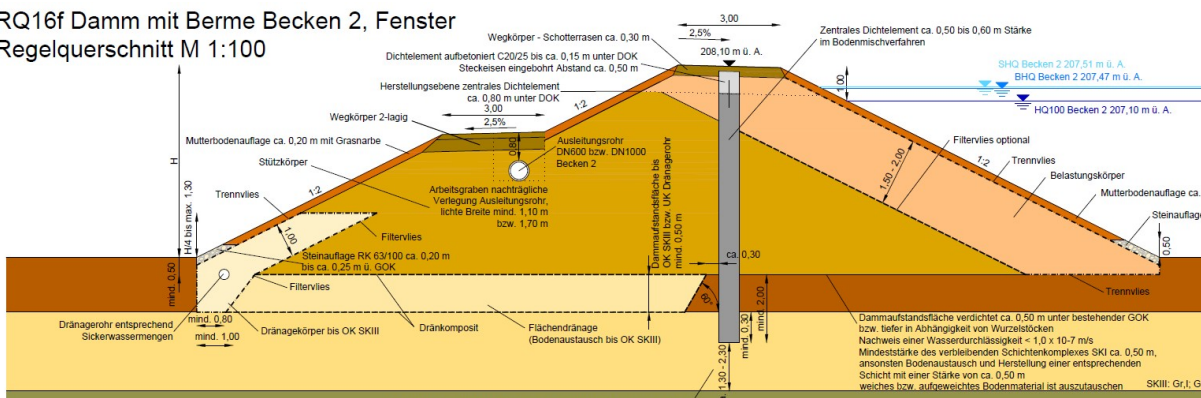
Detaillierter Dammaufbau, beispielhaft für RQ16f (Becken 2) für Dichtwand mit Fenster aus [17]
